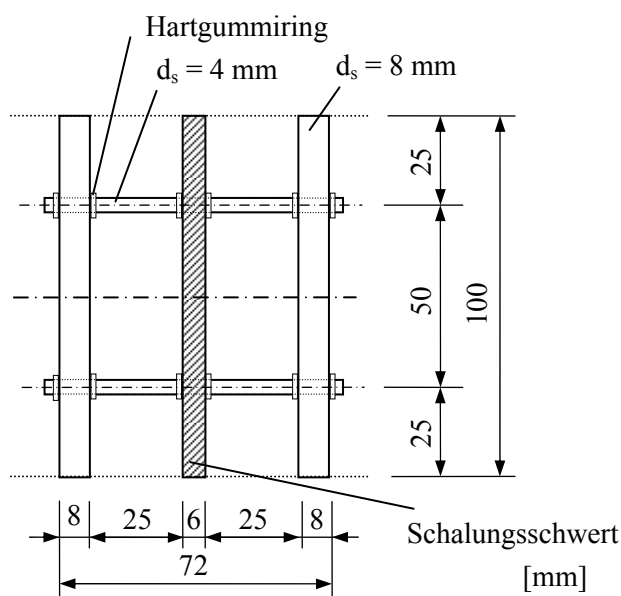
Befestigung der Bewehrungsstäbe an dem Stahl-Schalungsschwert
